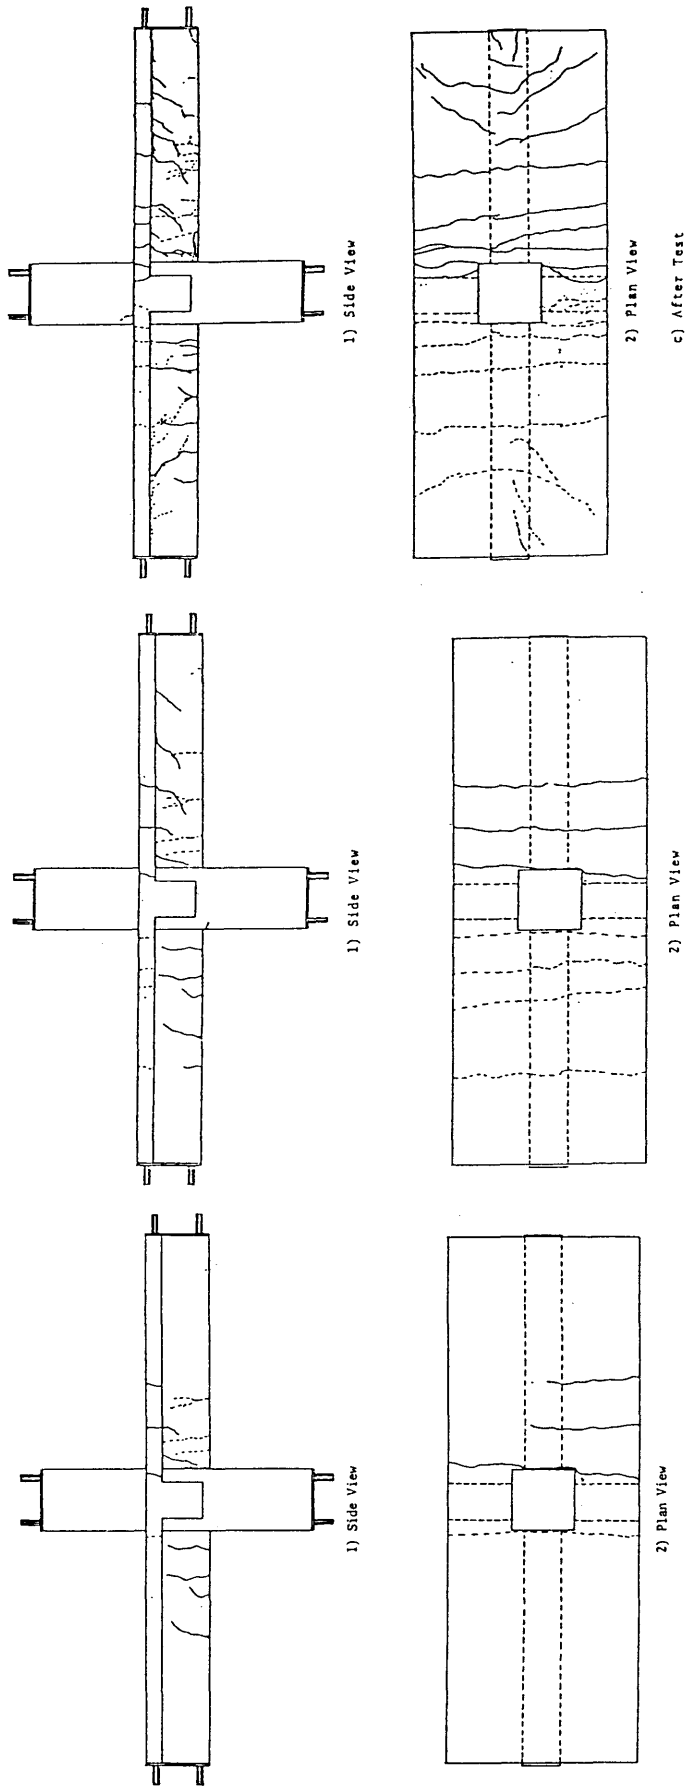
ひびわれ状況 (b) 試験体 I-2
